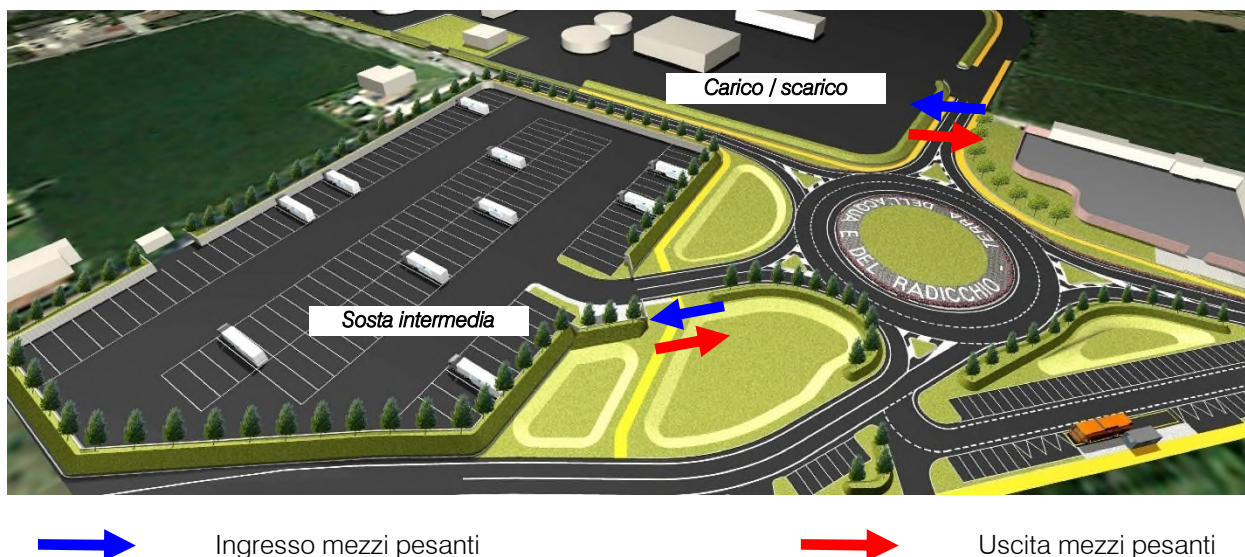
Accessi stabilimento e parcheggio esterno di progetto
